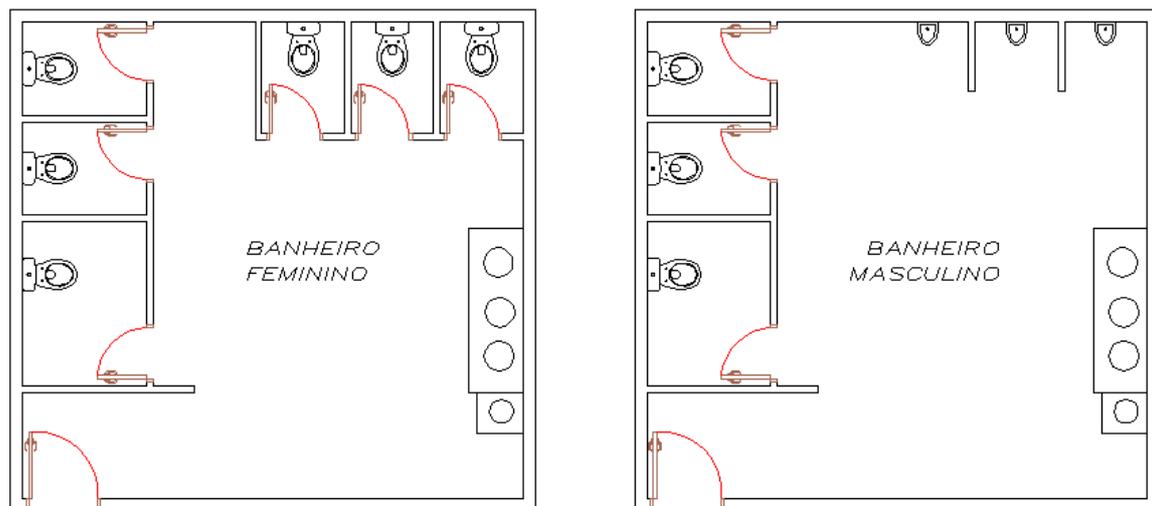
Proposta de planta baixa para reforma dos banheiros do clube
